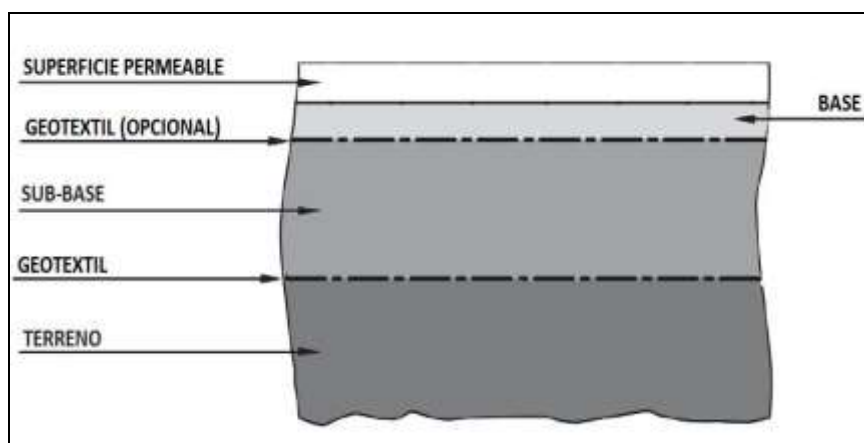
Sección tipo de un pavimento permeable. (Fuente: García Haba, 2011)
